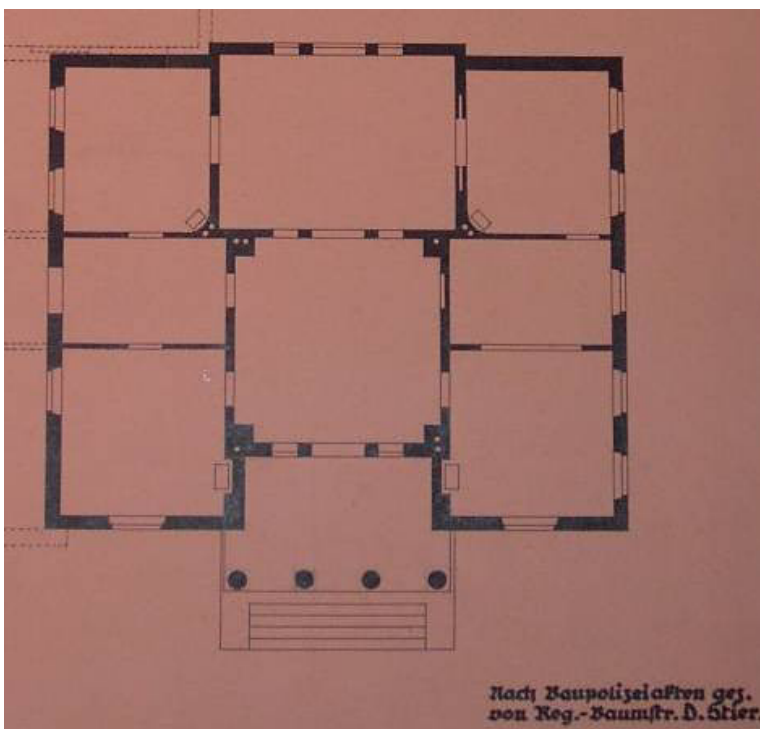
Contrescarpe 22, Ausschnitt des Grundrisses des 1822 von J. E. Polzin erbauten Landhauses, M. 1:100. Nach Baupolizeiakten gez. von Reg.-Baumstr. D. Stier, LfD Bremen, Planarchiv
